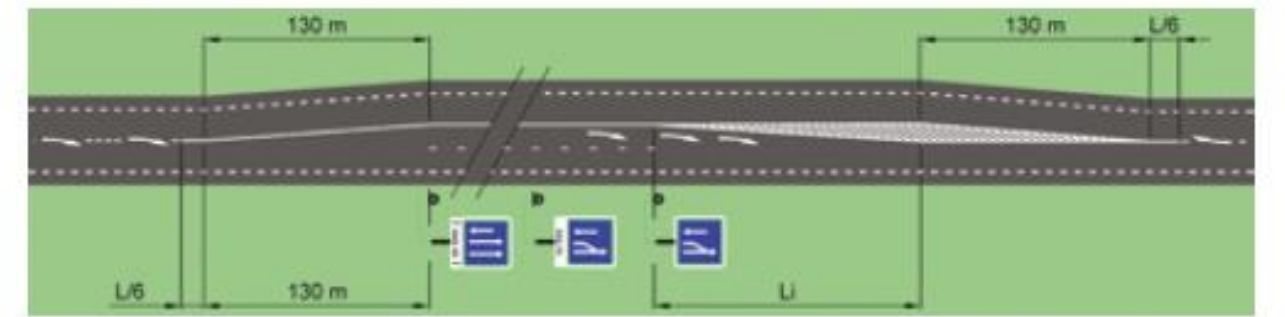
Schéma de construction d'un créneau de dépassement – ARP 2022
